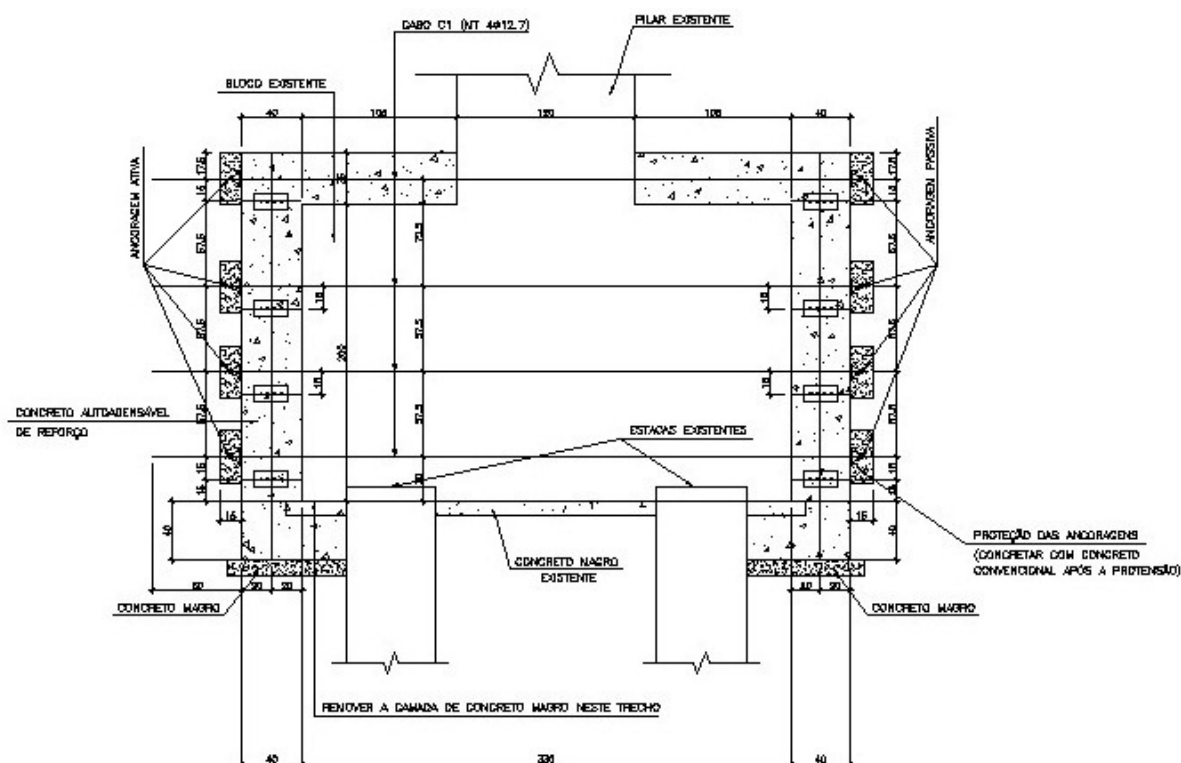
Detalhe do reforço do bloco com concreto auto adensável e protensão com cabos horizontais.
